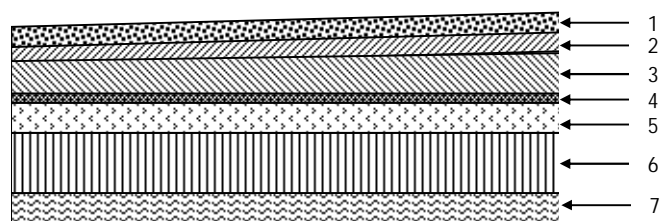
Plancher terrasse (dalle en corps creux)
